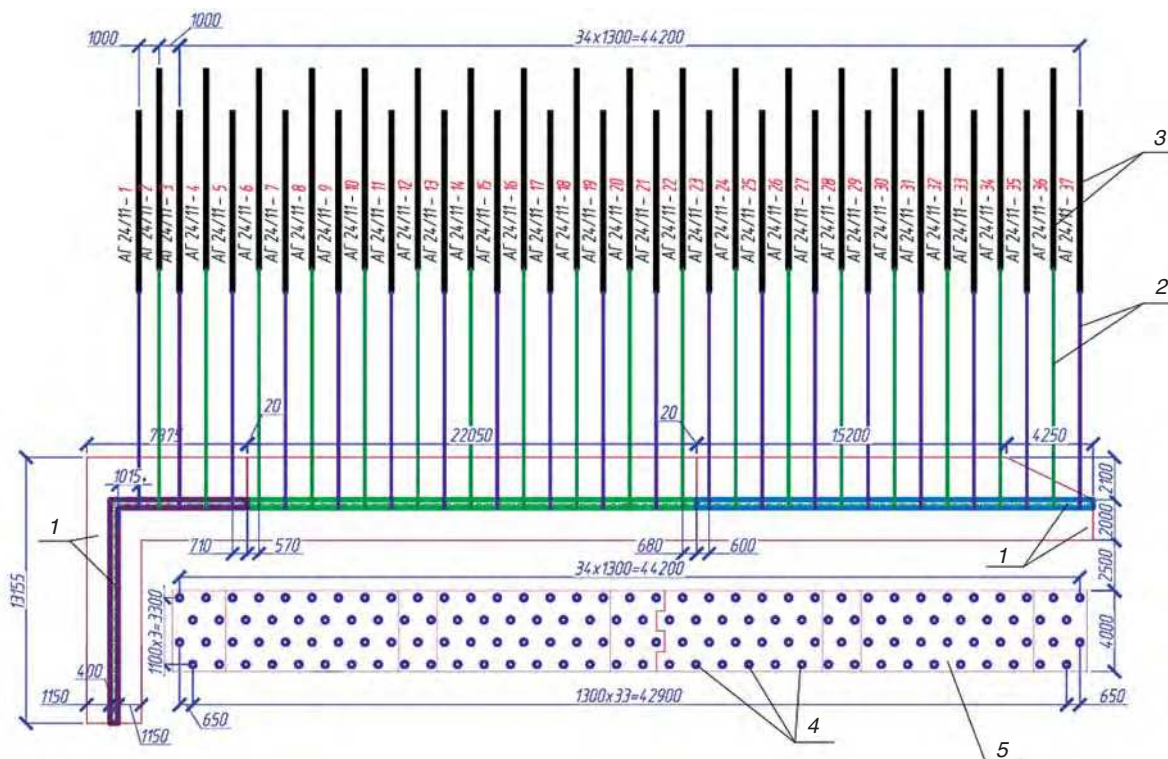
Схема устройства монолитных железобетонных ростверков и диафрагм на завершающем этапе: 1 – призматические железобетонные сваи; 2 – существующий монолитный угловой железобетонный ростверк; 3, 4 – грунтовые анкера ЭРТ; 5 – буроинъекционные сваи ЭРТ усиления основания
